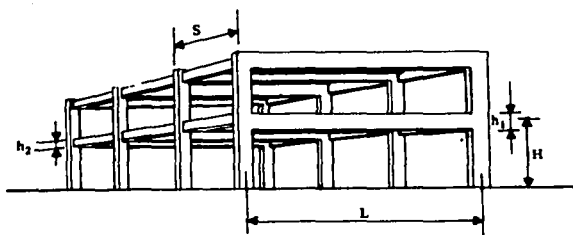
Estructura de concreto reforzado a base de columnas, traveses y losas perimetralmente apoyadas.
